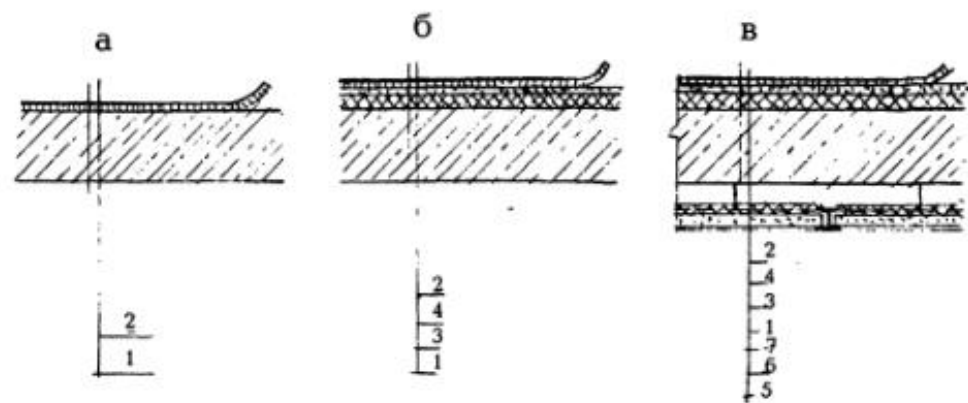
Повышение звукоизоляции междуэтажных перекрытий: а - исходная акустически однородная конструкция, б - конструкция со слонтым полом, в - то же, со слонтым полом и подвесным потолком; 1 - панель перекрытия, 2 - теплозвукоизолирующий линолеум (ТЗЛ), 3 - сплошная звукоизоляционная прокладка, 4 - стяжка из цементно-песчаного раствора, 5 - звукопоглощающий материал, 7 - воздушная прослойка
